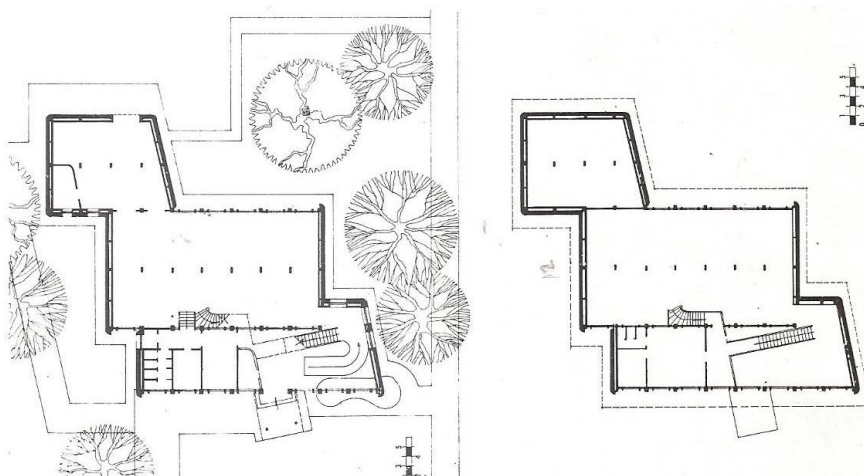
Grundriss des Erd- und Zwischengeschosses.
